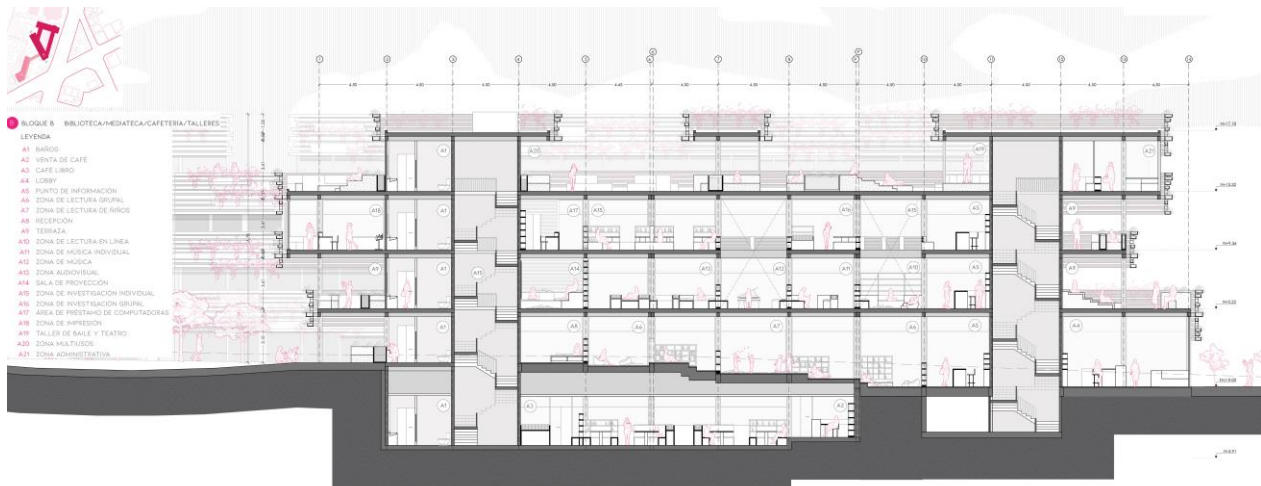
Corte longitudinal del Bloque B1. Fuente: (Andrade, 2019).
